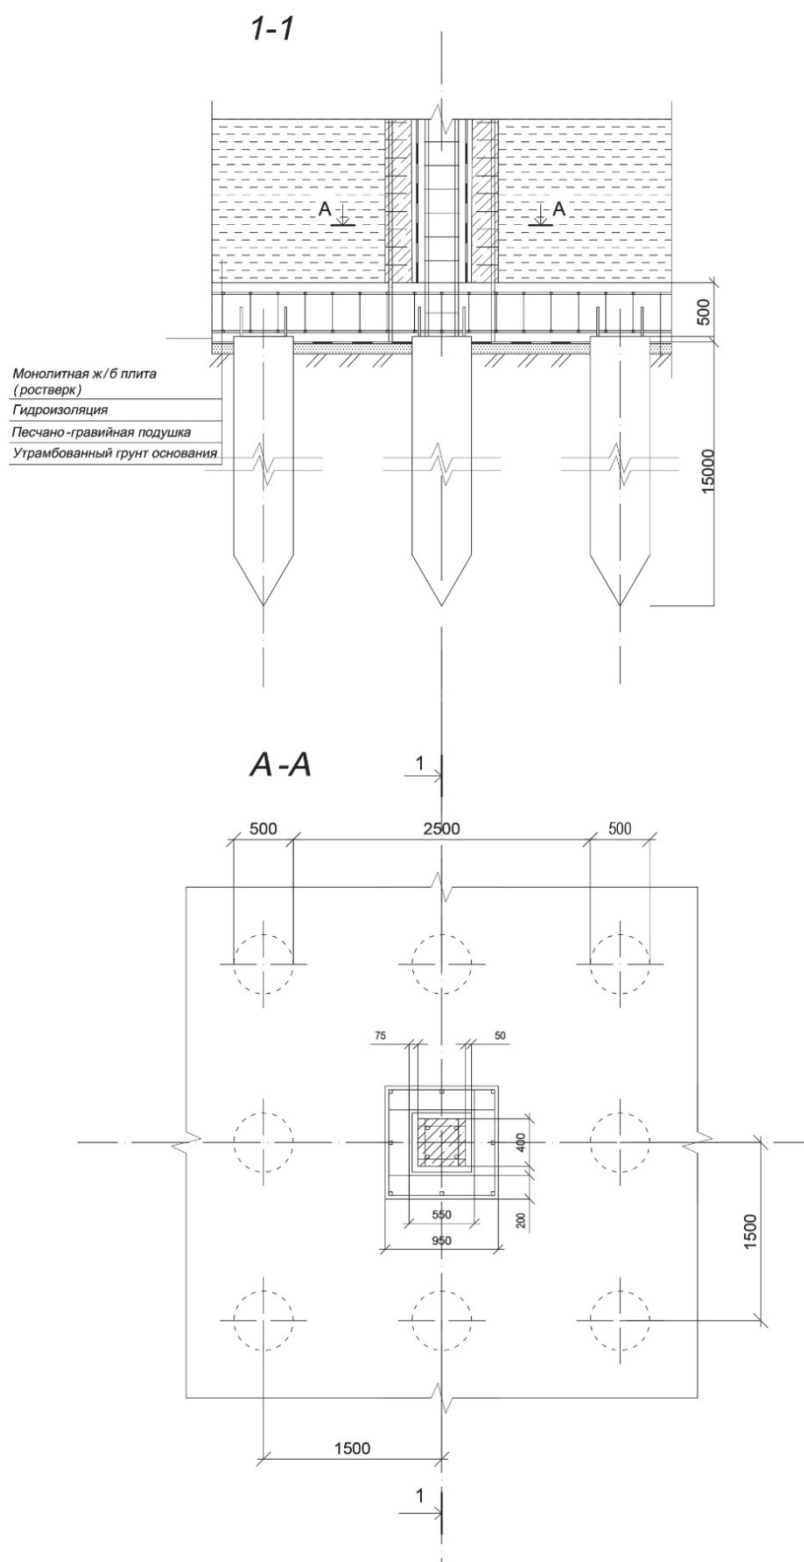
Узел пересечения железобетонной колонны с фундаментом (монолитная ж/б плита в виде ростверки на буронабивных сваях).
